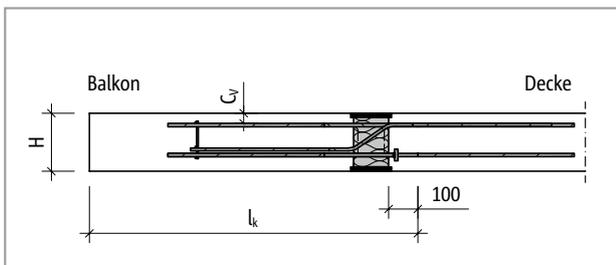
Schöck Isokorb® XT Typ C: Statisches System
